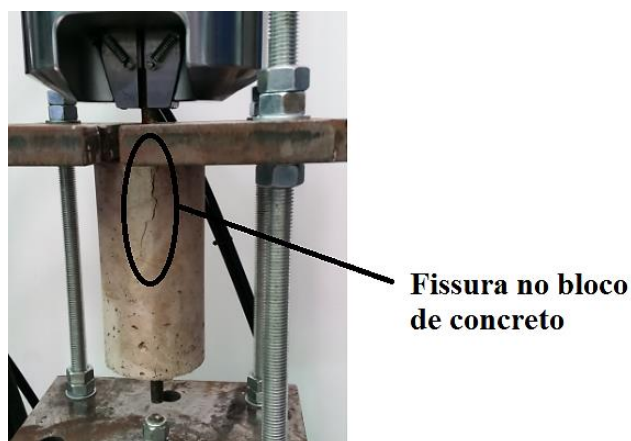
Surgimento de fissura durante o ensaio de arrancamento.
